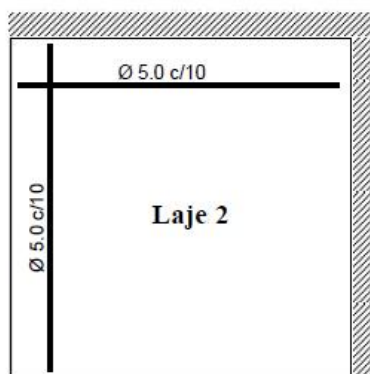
Laje apoiada/engastada. Fonte: Chaves (2010).
